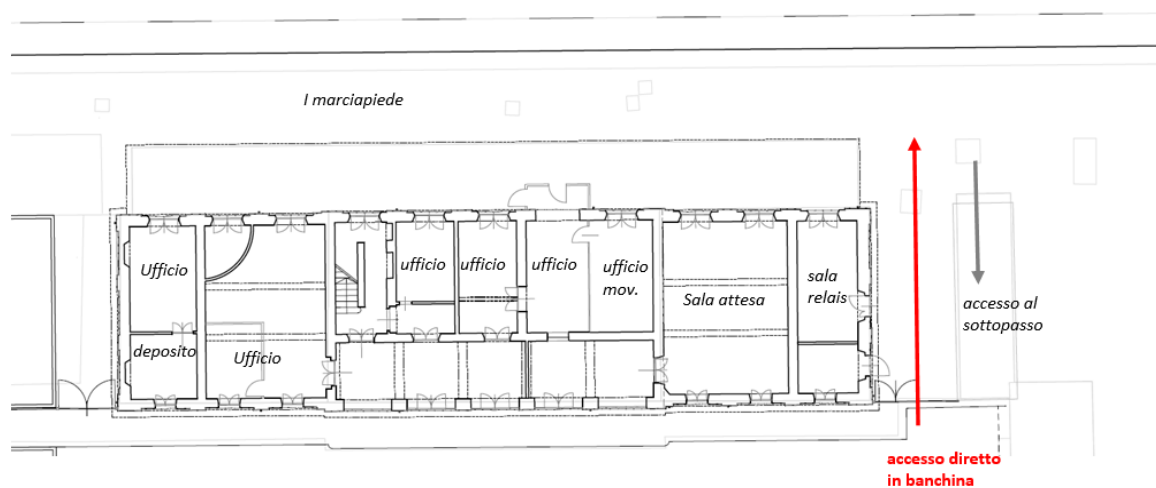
Planimetria piano terra fabbricato viaggiatori – ante operam
